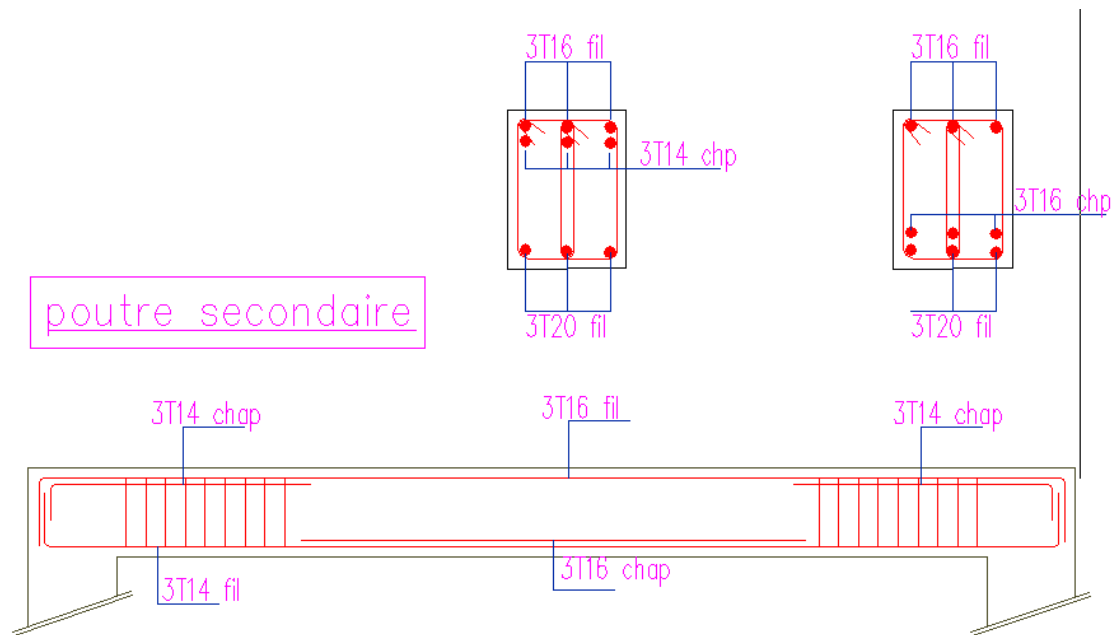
Ferrailage d'une poutre secondaire de la soupenite
